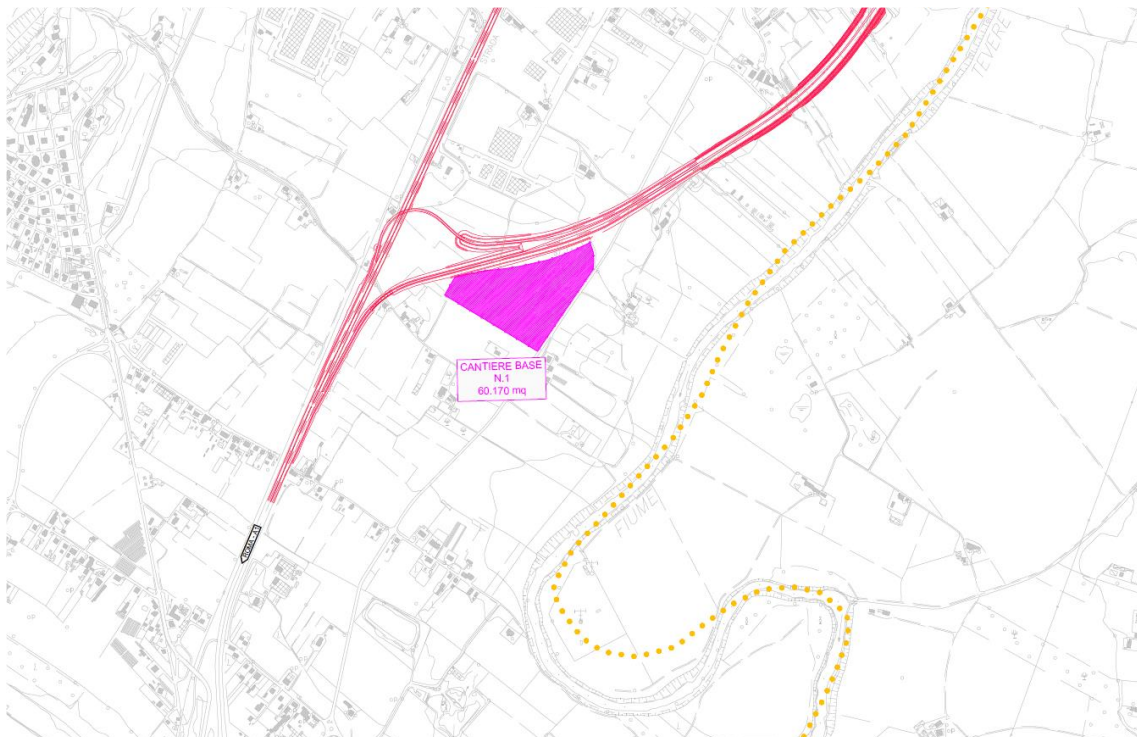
Stralcio planimetrico del tratto intermedio ad est e ad ovest del Tevere
